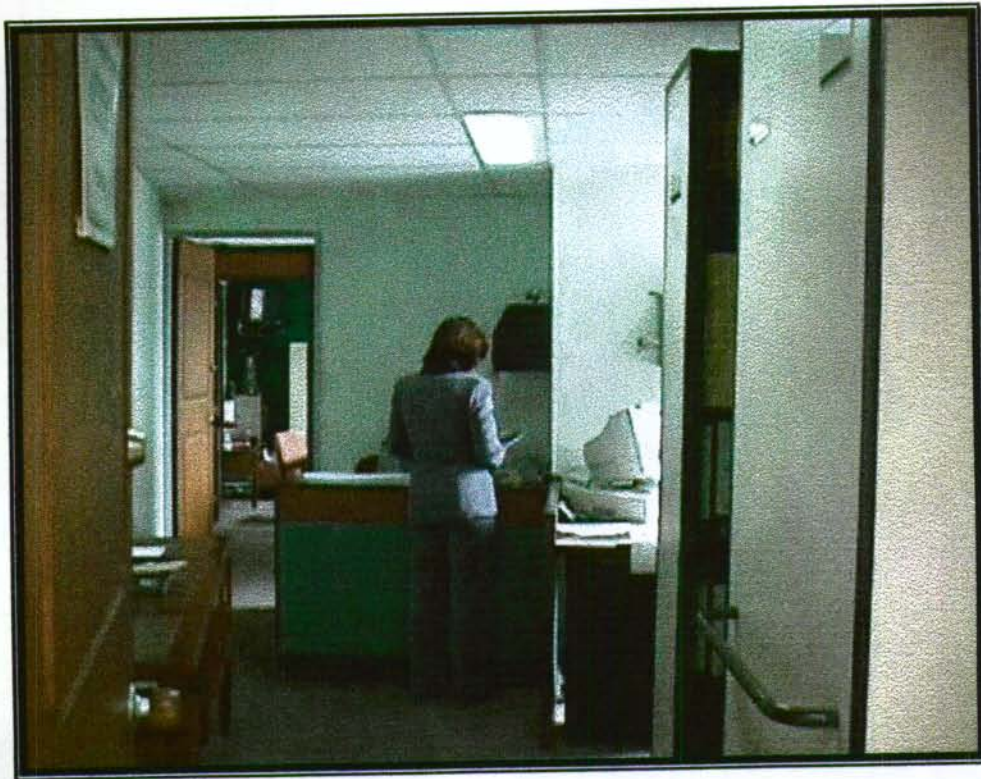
ZONA DE OFICINAS DE GERENCIA – ESTRUCTURA EN PORTICOS DE CONCRETO
